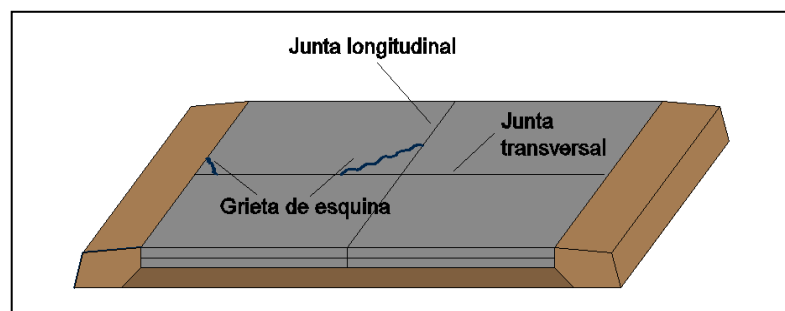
Esquema de grietas de esquina en la calzada
